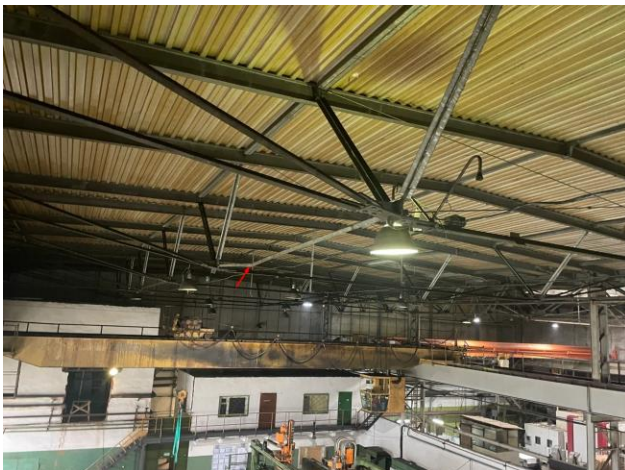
Прогиб элемента конструкции покрытия по нижнему поясу.
